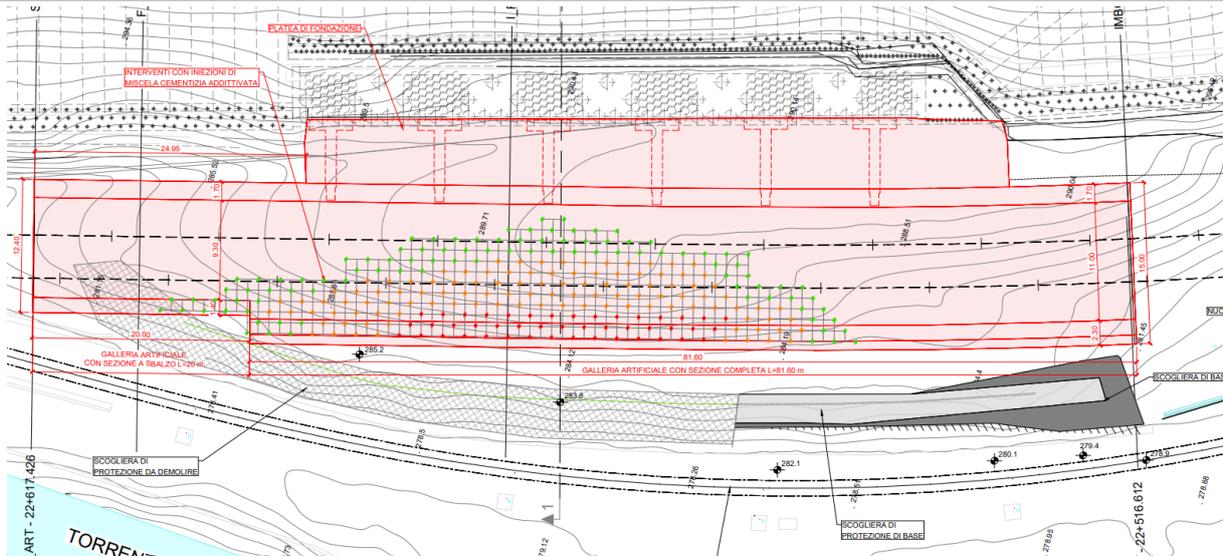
Stralcio della planimetria con ubicazione dei consolidamenti.
